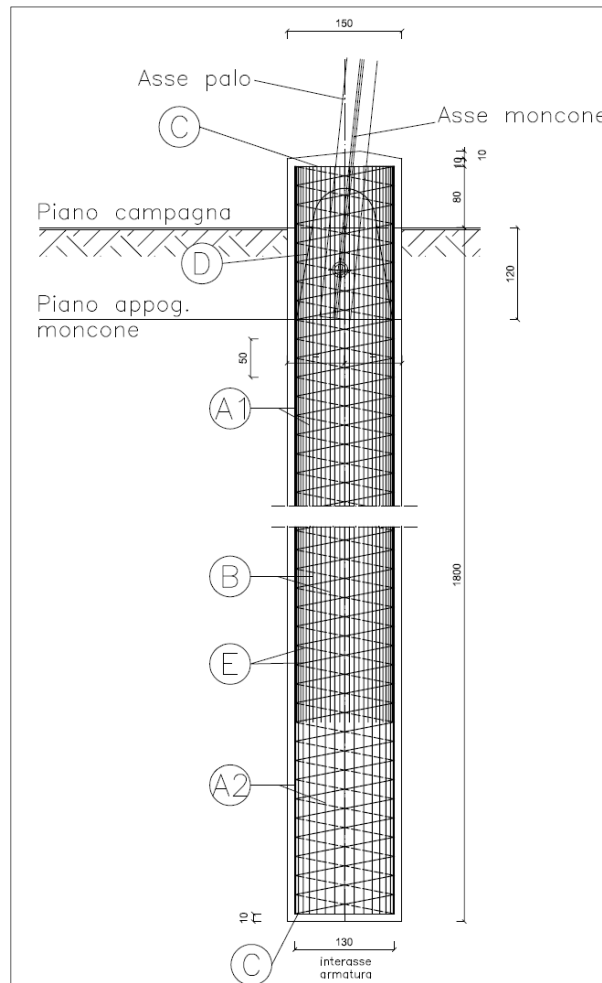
Schema tipo di fondazione profonda su pali trivellati per sostegni a traliccio.
